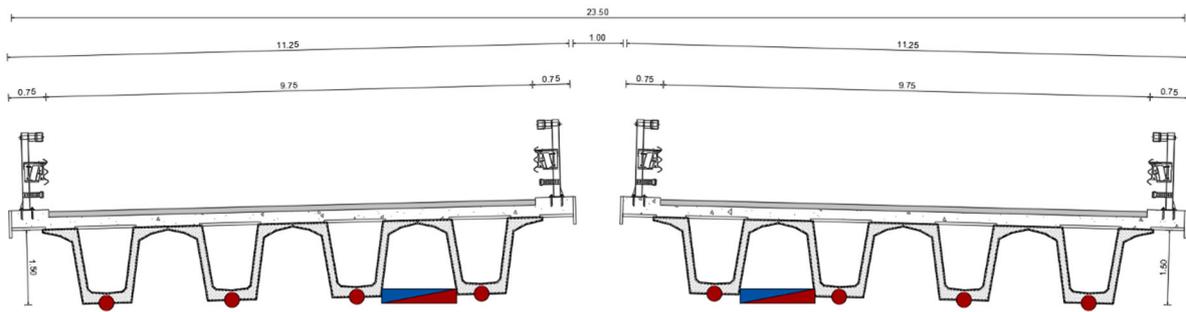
Ubicazione sensori su impalcato sezione a 4 travi (sezione trasversale VI01)
